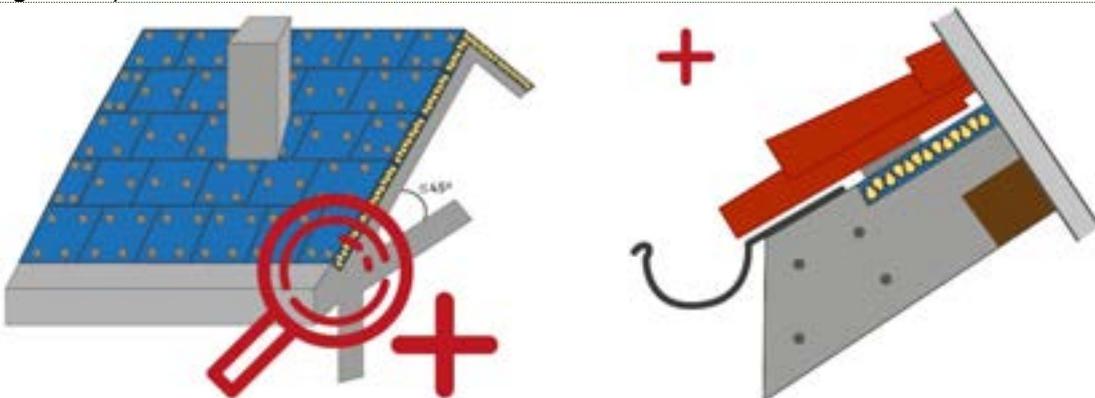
Colocación de las tejas adheridas a las planchas de XPS ranuradas
